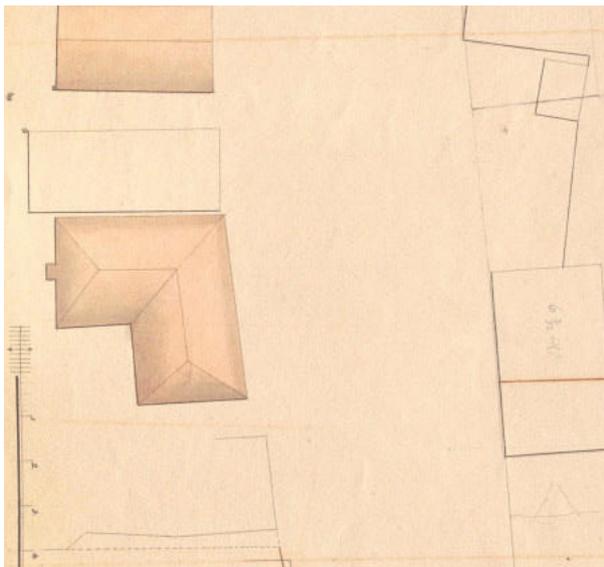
Ausschnitt aus dem Wiederaufbauplan mit den erhaltenen Bestandsbauten auf dem Grundstück Hauptstr. 22. Der winkelförmige Bau bezeichnet den Kernbau des heutigen Haupthauses.
